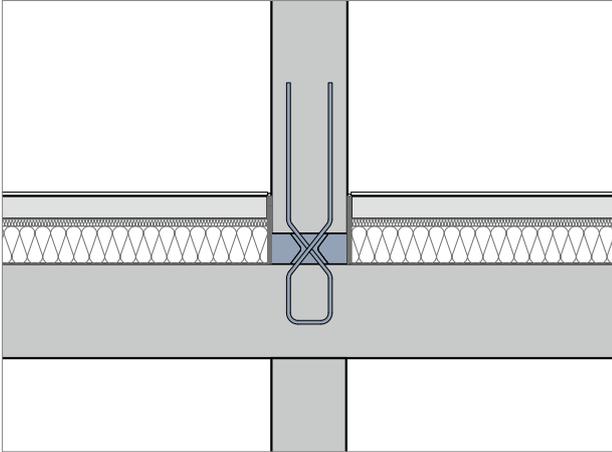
Schöck Sconnex® type W pour mur intérieur et isolation sur la dalle
